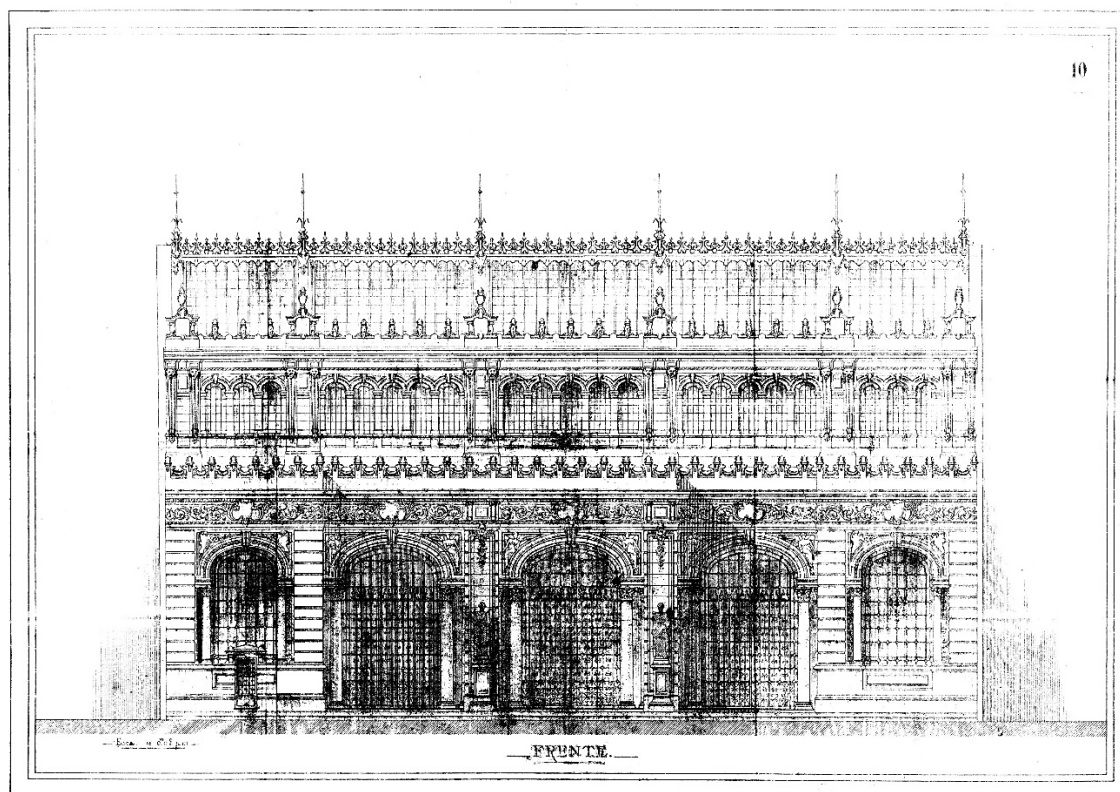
Vista del proyecto definitivo Plano N° 10 DNOA
